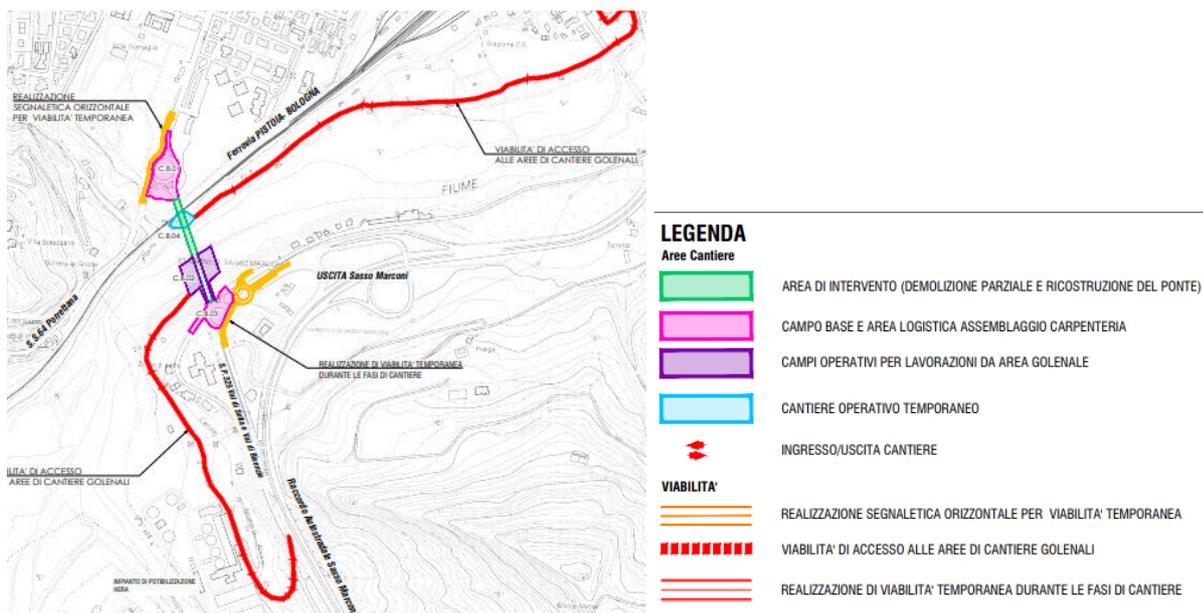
Cantierizzazione. Planimetria di inquadramento (Fonte: Allegati alla Lista di controllo)
